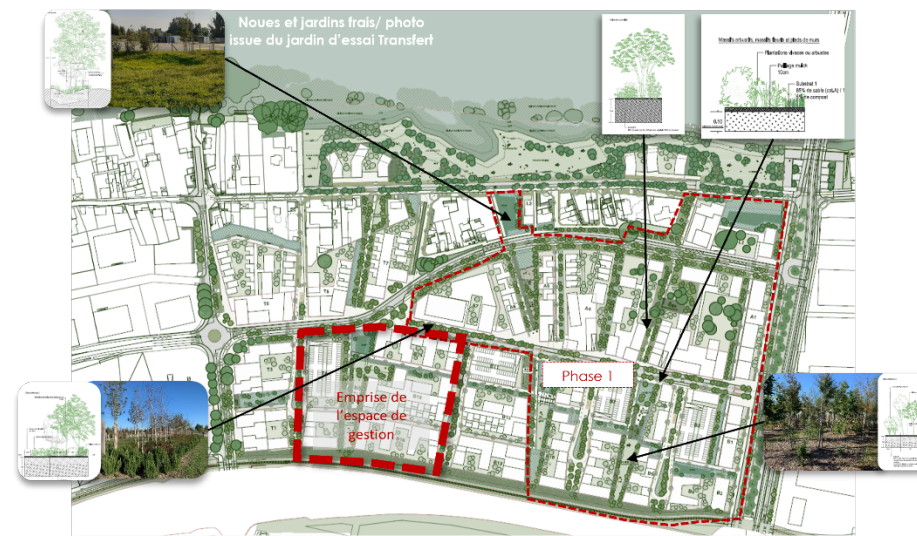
Plan d'aménagement des espaces vert du secteur Basse Isle
